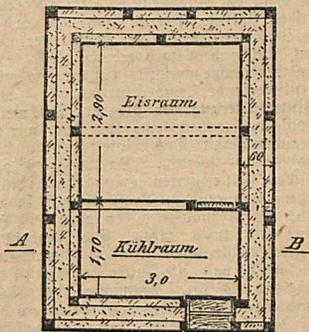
Holzernes Eishaus mit Kühlraum. Grundriss.
